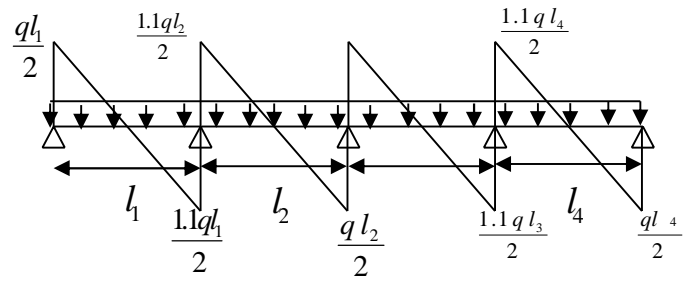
Effort tranchant d'une poutre à plus de 2 travées
